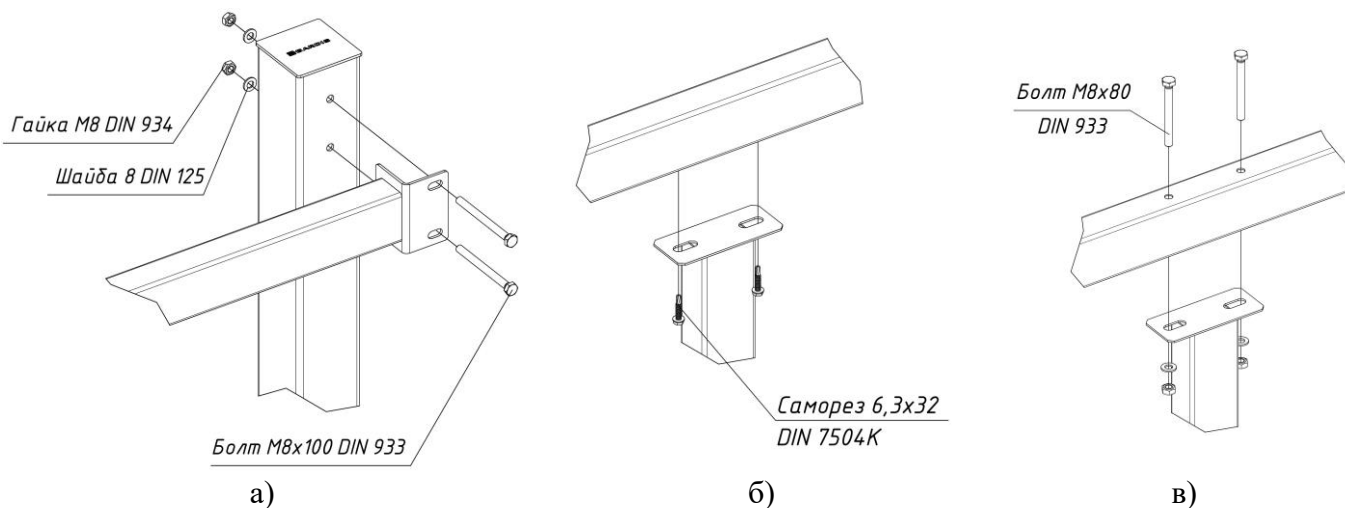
(а – монтаж горизонтальной перемычки, б – монтаж вертикальной перемычки на саморезы, в – монтаж вертикальной перемычки болтовым соединением.)
